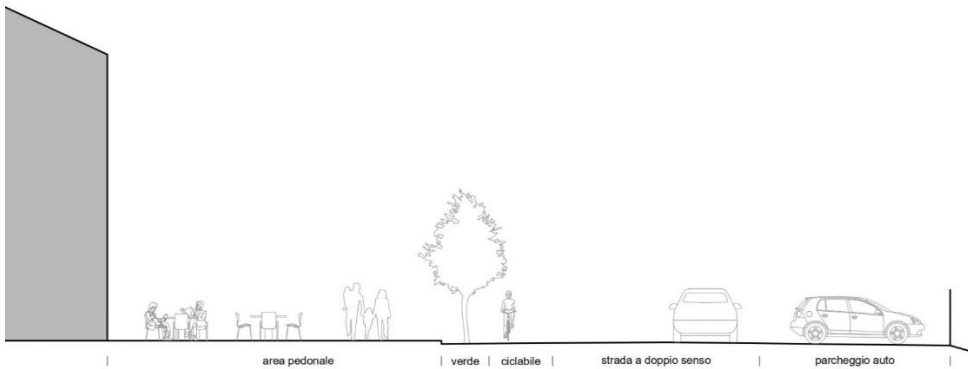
Focus progettuale: La piazza fuori le mura. Planimetria e sezione stato post intervento.
